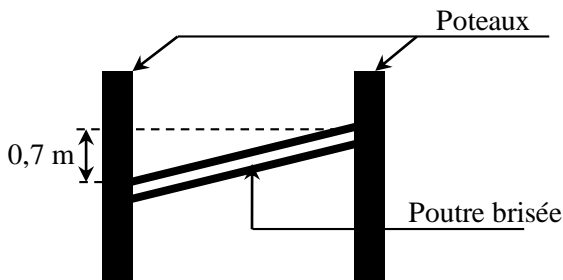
Vue en élévation de la poutre brisée Figure III.37. Schéma statique de la poutre brisée
